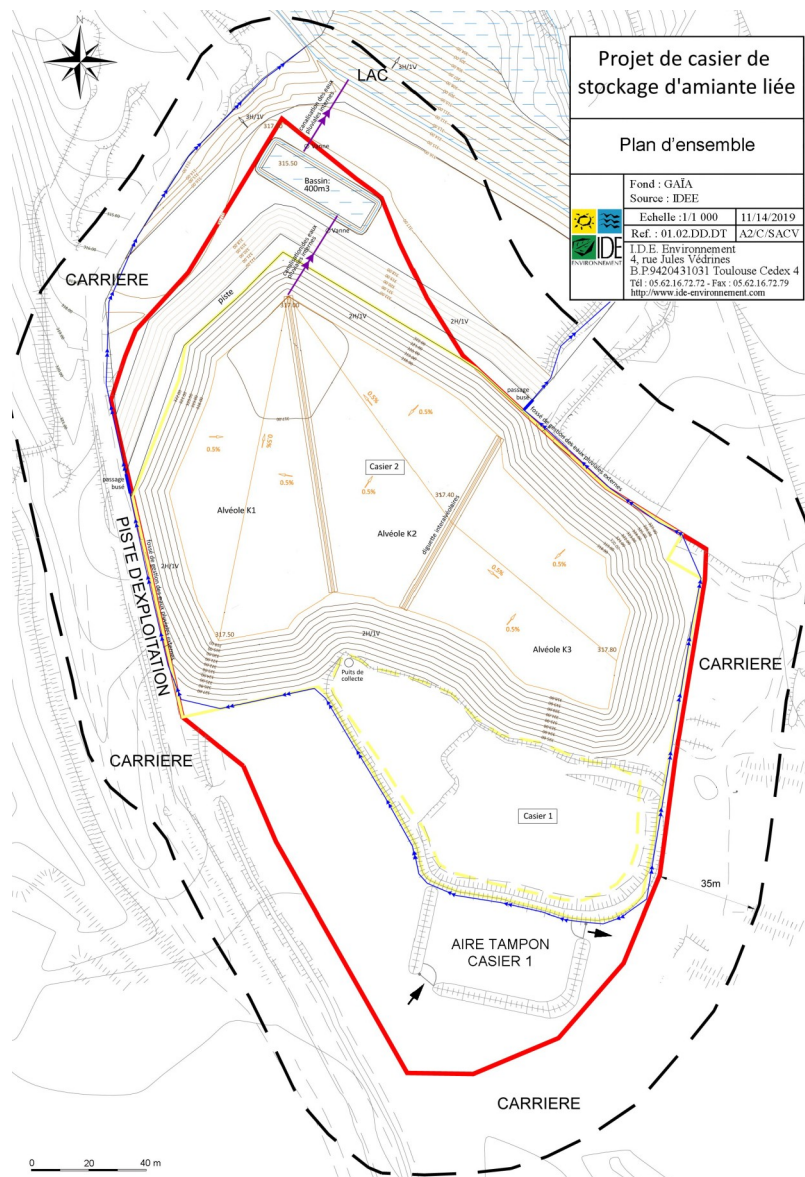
plan d'ensemble de l'installation de stockage de déchets non dangereux
